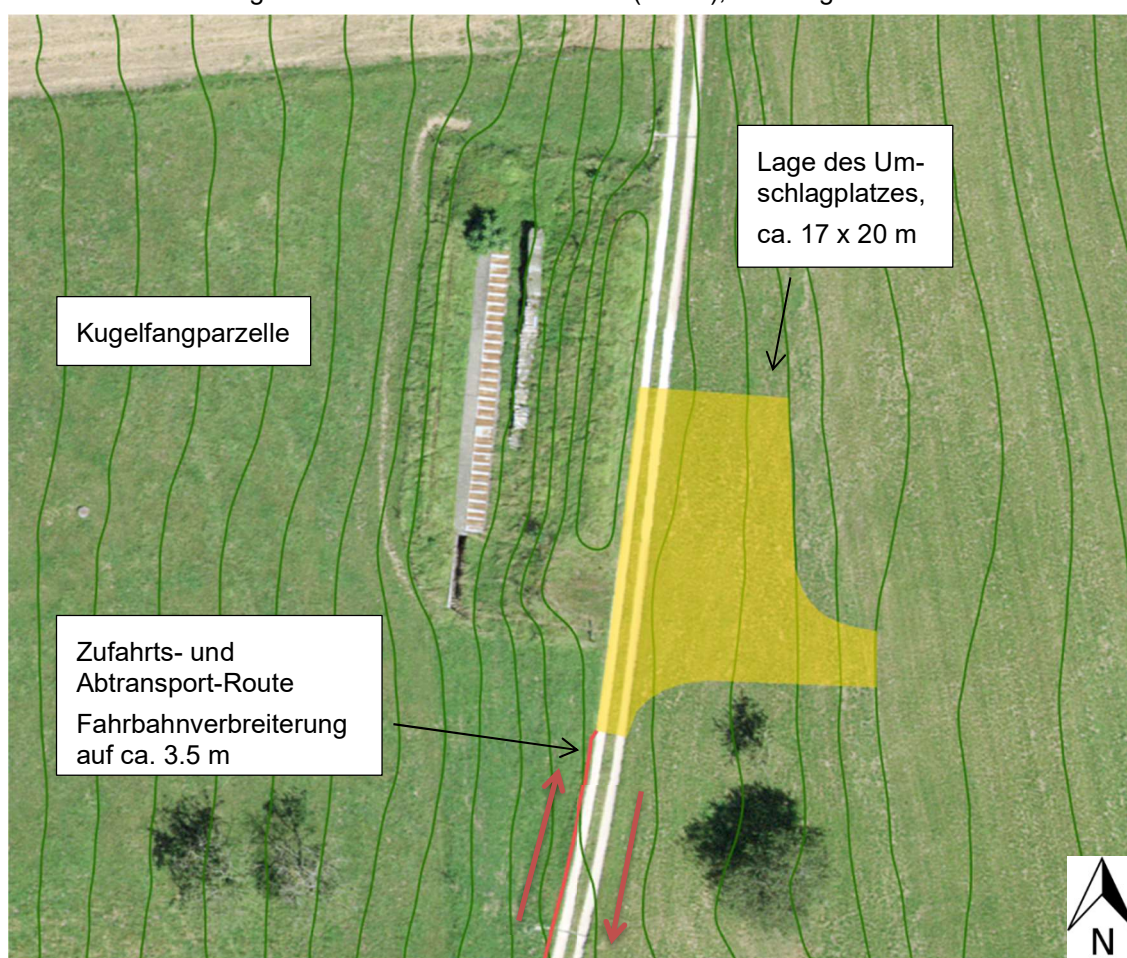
Baustelleninstallation und Erschliessung über Wegparzelle 18, Umschlagplatz mit Wendemöglichkeit
